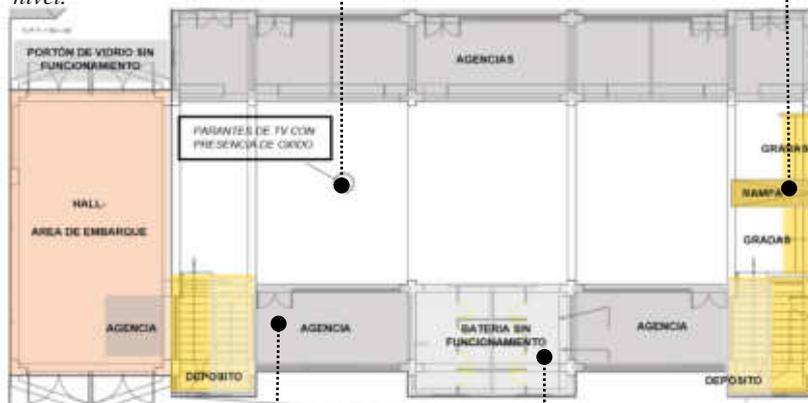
Planta según estado situacional del Primer Nivel del bloque "B".
